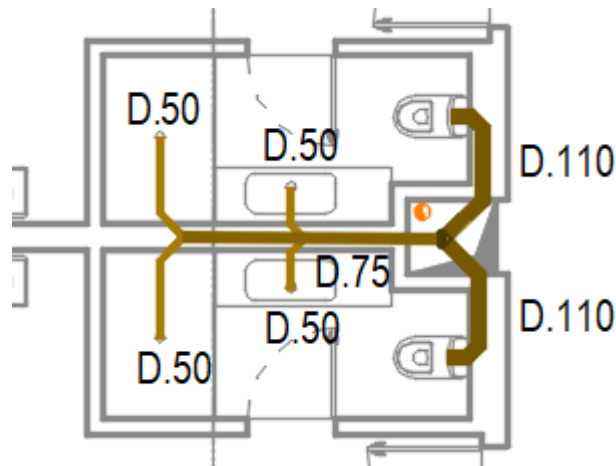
Planimetria e Shkarkimit të Ujerave të Ndotura në Një Nyje Sanitare
